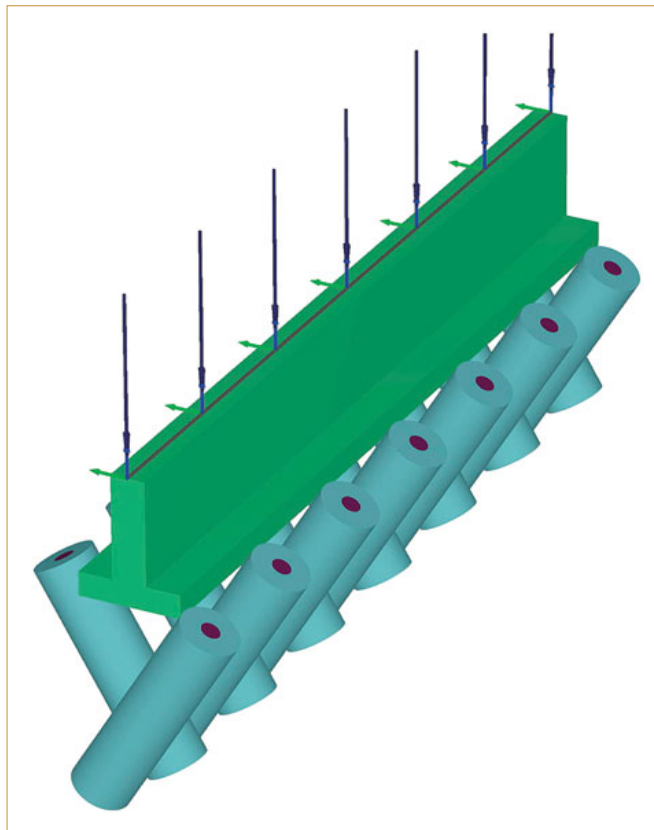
Пример расчетной схемы усиления основания существующего ленточного фундамента щебеночными скважинами
